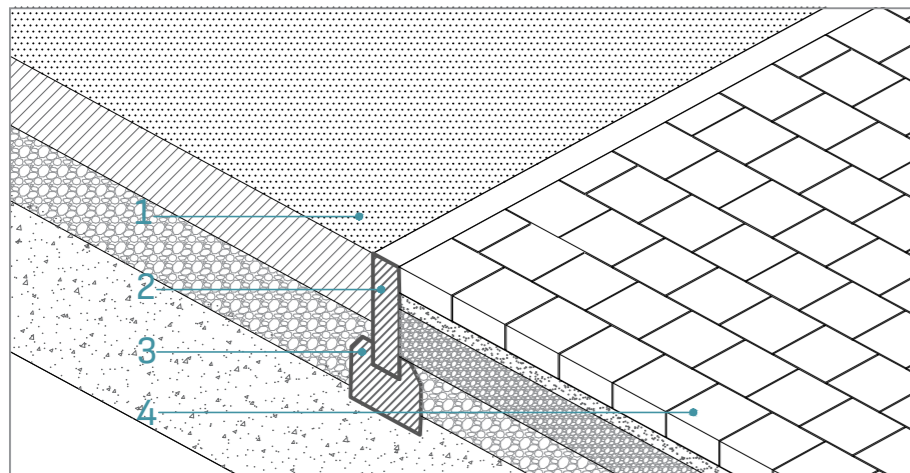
Разделителна ивица с фундамент между настилка от плочи или павеа и усилената настилка от асфалт
